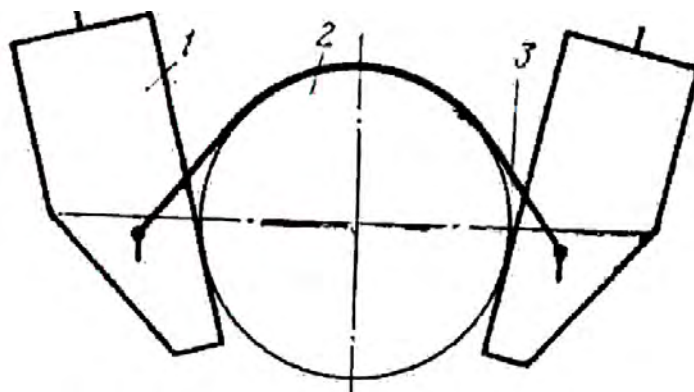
Конструкция утяжелителя типа УБО: 1 — железобетонные блоки; 2 — трубопровод; 3 — силовые пояса
